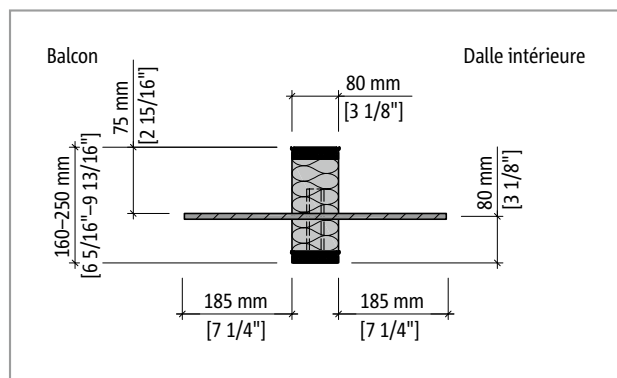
Schöck Isokorb® T Type CH-NN1 : coupe transversale du produit
